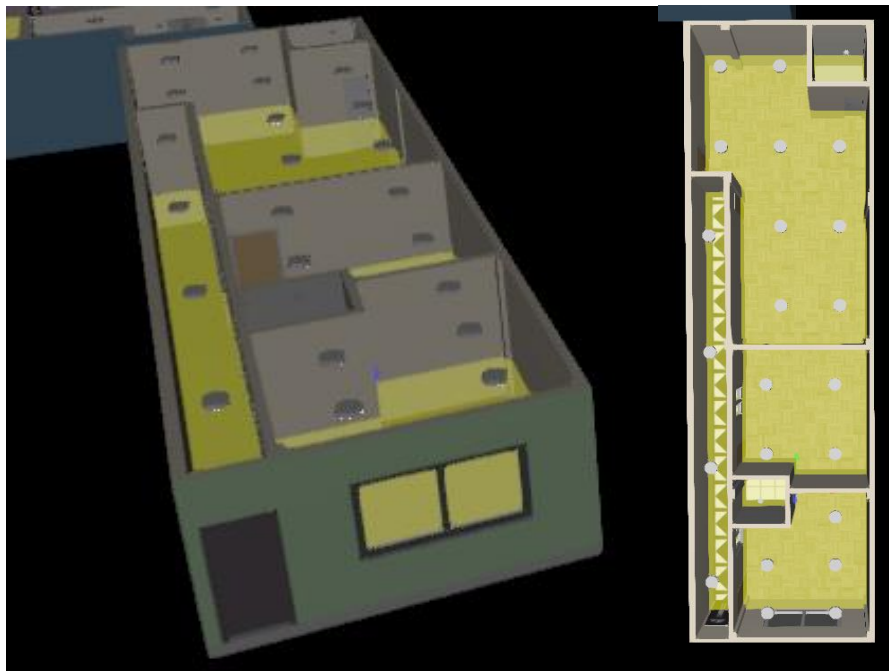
Renderizado y ubicación de luminarias en la planta baja del bloque destinado a la sacristía.
